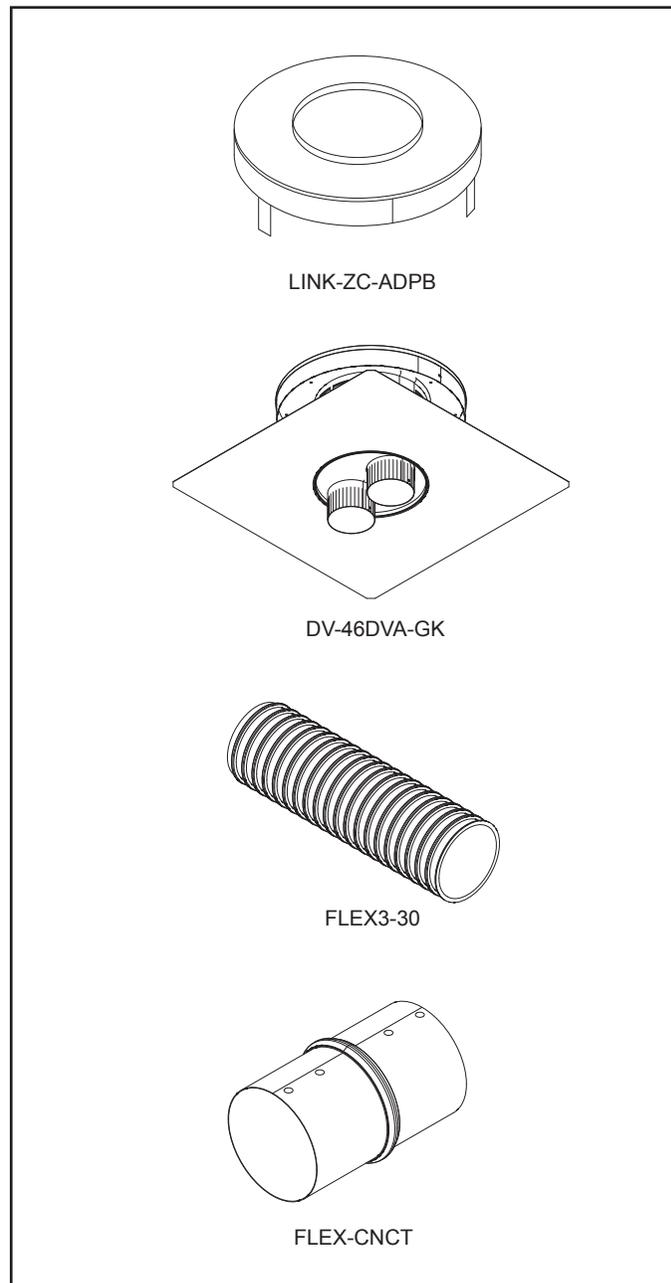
Ensembles d'accessoires de doublage de conduit flexible d'évacuation directe
